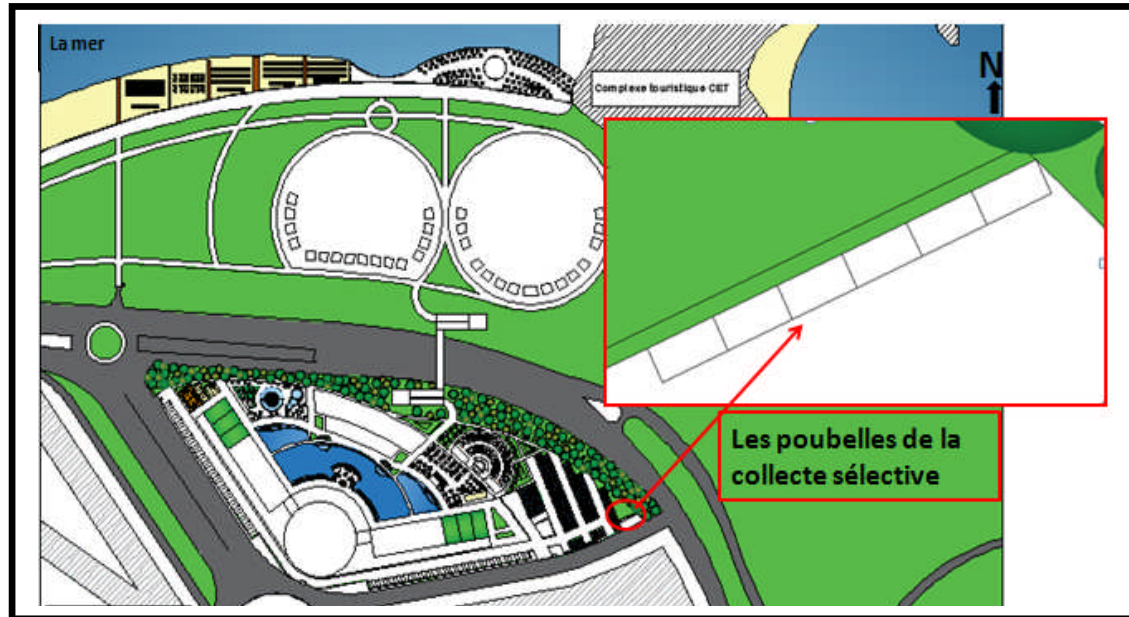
le positionnement des poubelles de collecte au niveau du plan de masse
